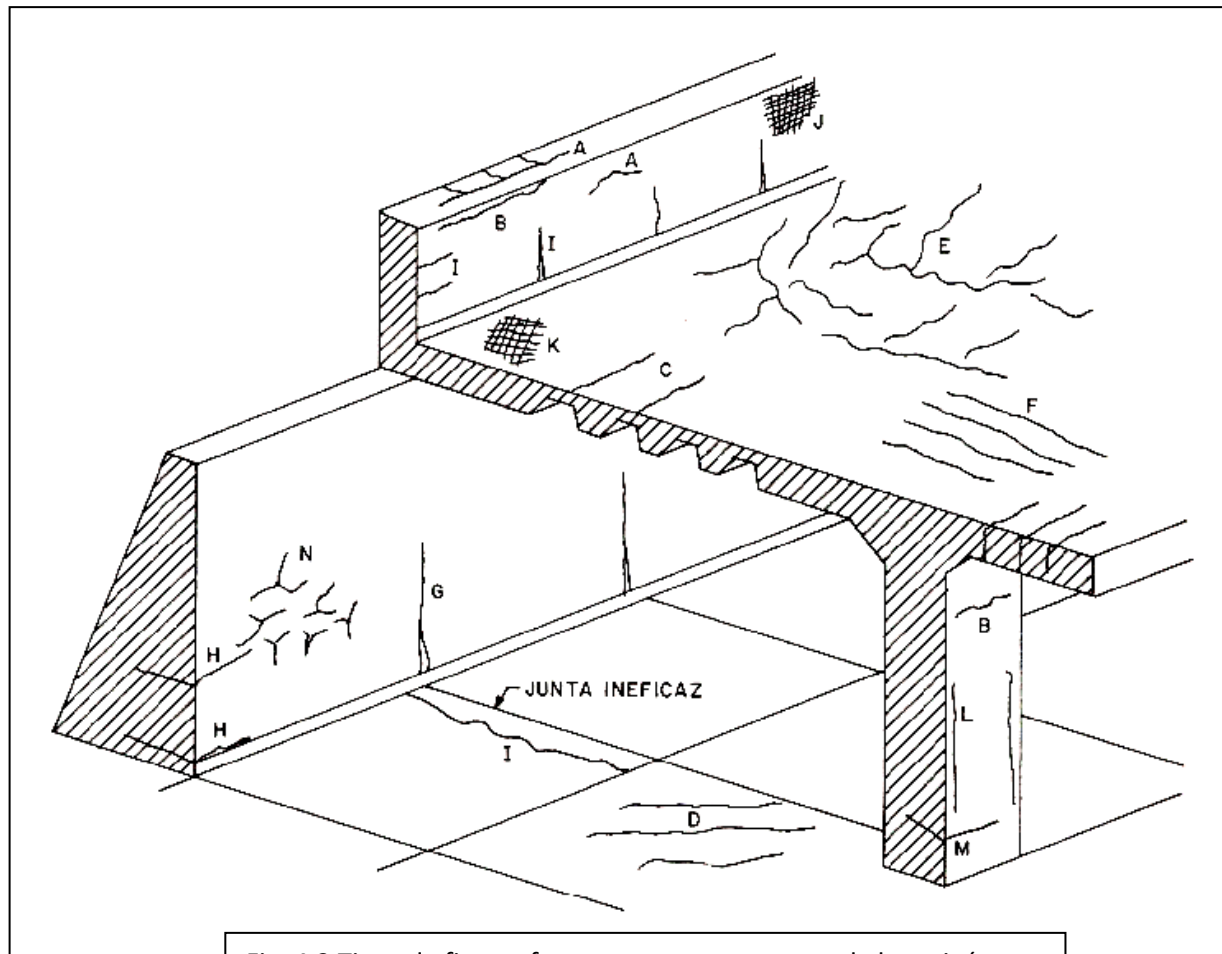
Tipos de fisuras frecuentes en estructuras de hormigón
